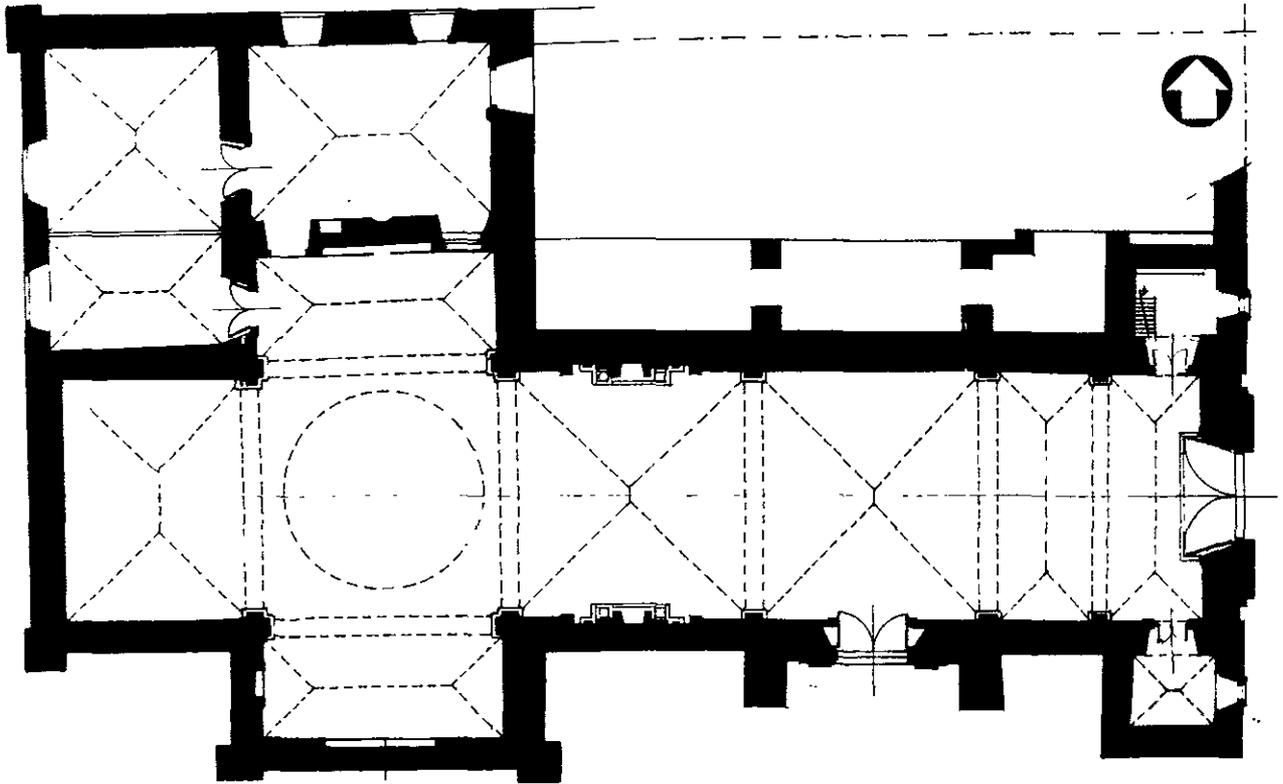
Planta baja arquitectónica del conjunto.<sup>54</sup>
